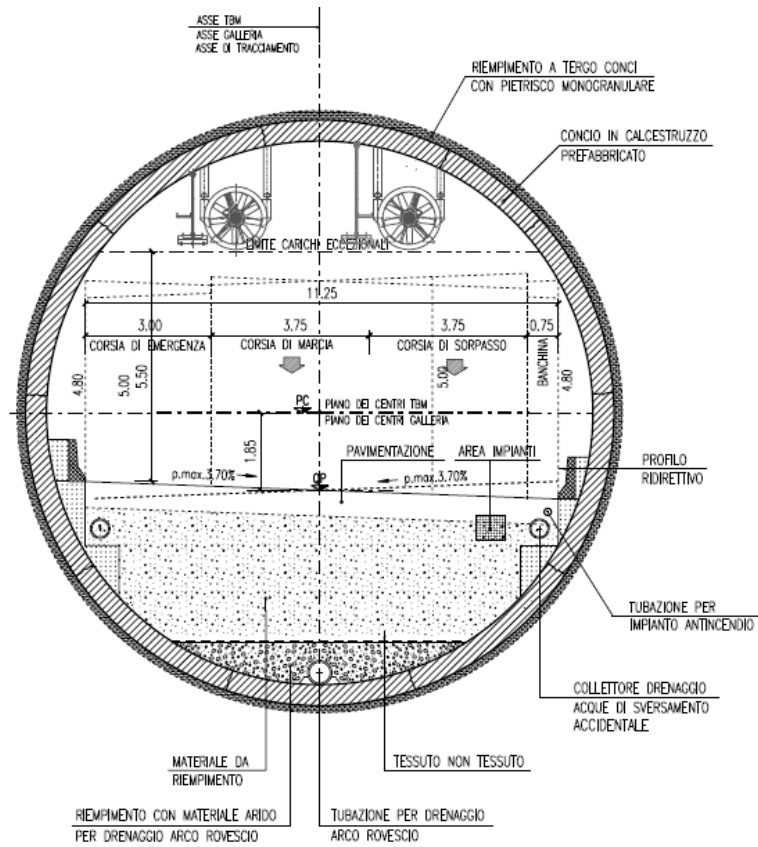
sezione tipo in galleria naturale con scavo meccanizzato
